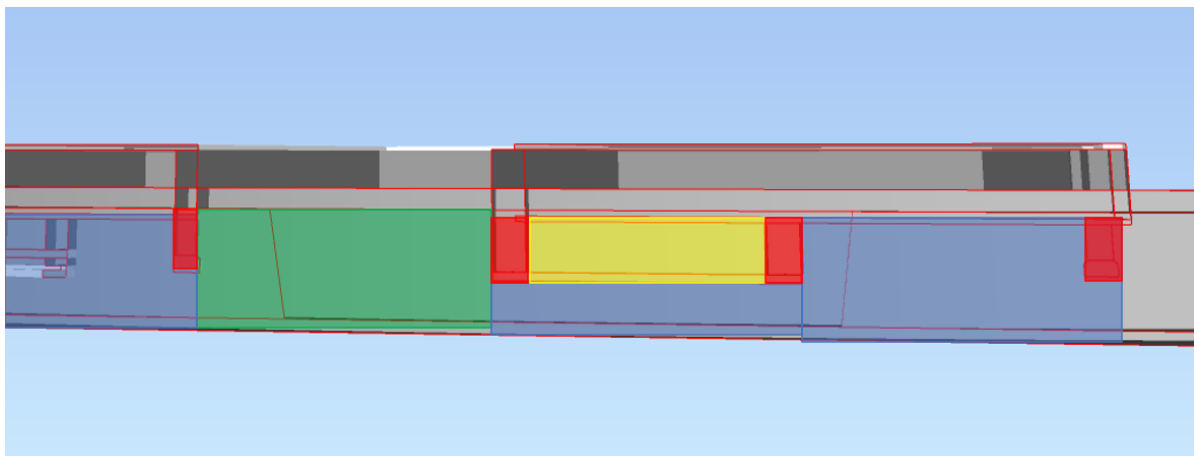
Schnitt B – B Westwand Tunnel (Süd)
